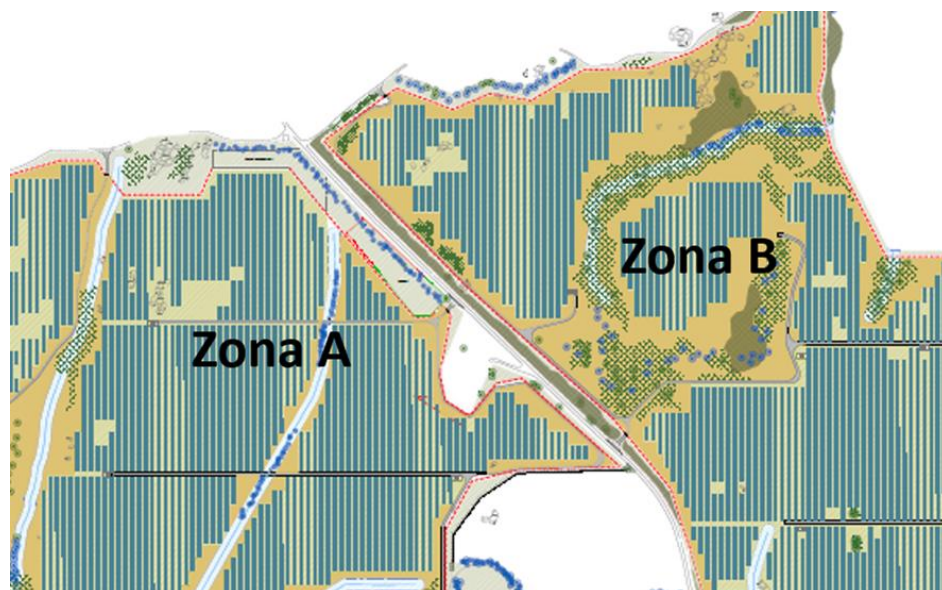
Extrato do PIP: zona de circulação entre zonas A e B.
